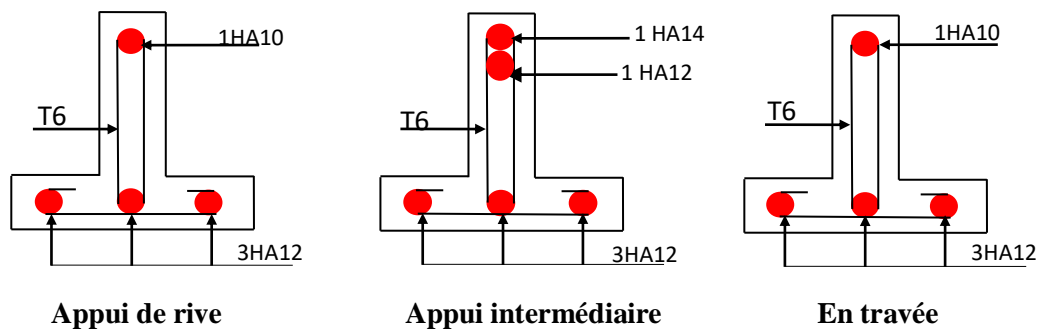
Ferrailage des poutrelles du plancher 1^{ère} à 9^{ème} étage
